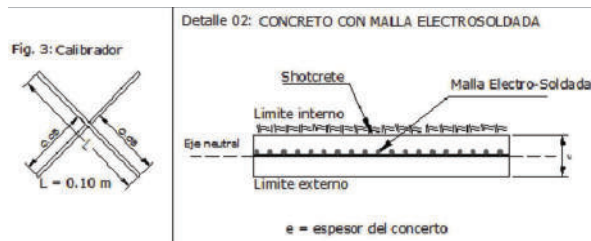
Perfil de Concreto Proyectado (Shotcrete).
